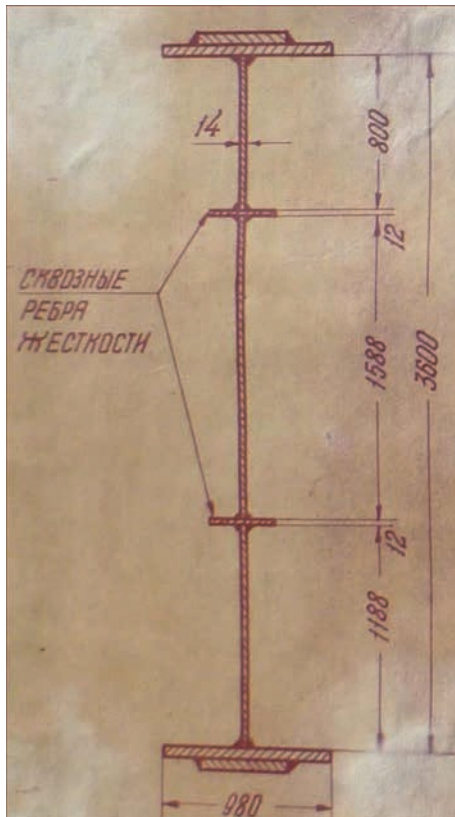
Поперечний переріз ферми головних поздовжніх балок чотирьох- та п'ятипрогонових споруд мосту [4]
